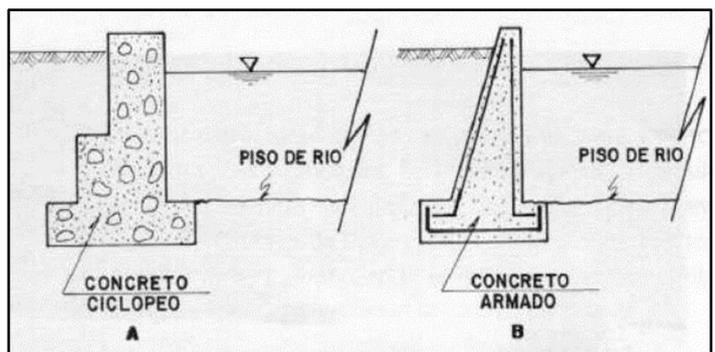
Muro de concreto, extraído de Diseño y construcción de defensas ribereñas Terán 1998 (31).
